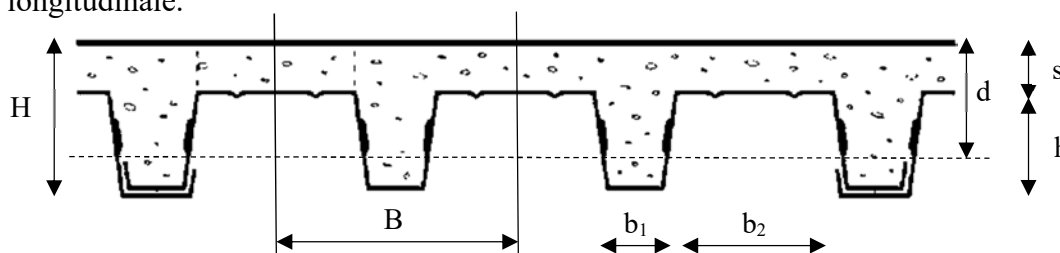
Sezione trasversale di una soletta mista in acciaio-calcestruzzo
